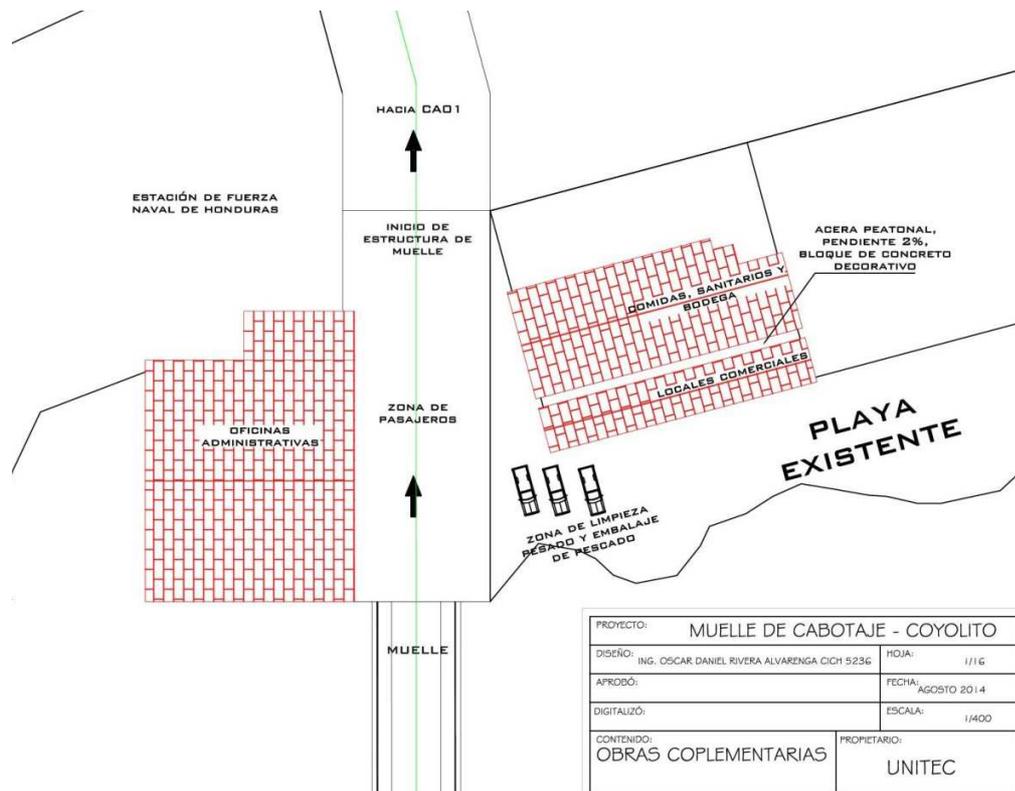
Vista en planta de propuesta para zona de arribo de pasajeros.
